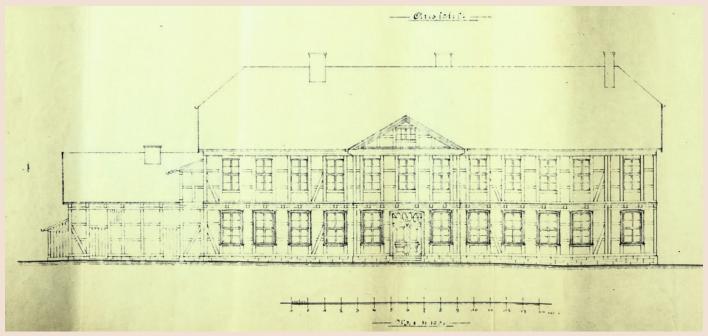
Der nach 1915 gezeichnete Aufriss des Chemischen Laboratoriums zeigt die Fassade mit dem Anbau an der Westseite
